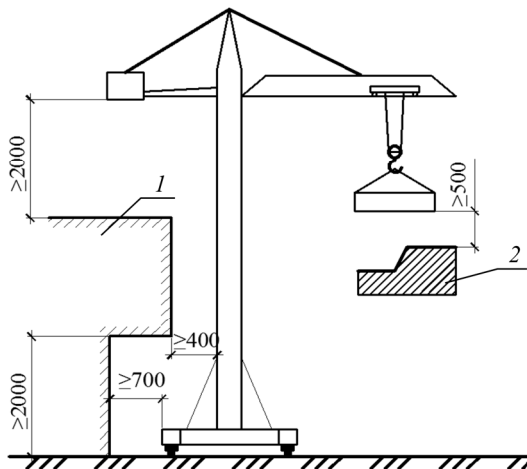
Схема установки кранов, передвигающихся по наземным крановым путям: 1 – возводимое здание; 2 – элементы строительной площадки (штабели грузов, части зданий и сооружений и т.п.)
